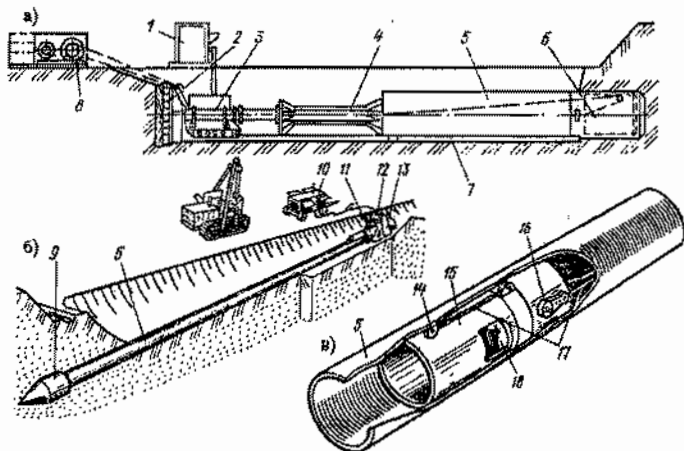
Установка У-12/60 для продавливания труб больших диаметров и виброударная установка УВГ-51: 1 - гидропривод; 2 - упорный башмак; 3 - гидродомкрат; 4 - нажимной патрубок; 5 - труба (футляр); 6 - головка; 7 - направляющая; 8 - лебедка; 9 - конусный наконечник; 10 - передвижная электростанция; 11 - корпус установки с расположенным внутри него вибромолотом горизонтального действия; 12 - электродвигатель; 13 - порталная рама; 14 - неподвижный блок; 15 - стакан; 16 - вибромолот с электроприводом; 17 - канаты для перемещения желонки внутри трубы (футляра); 18 - окно для разгрузки грунта
